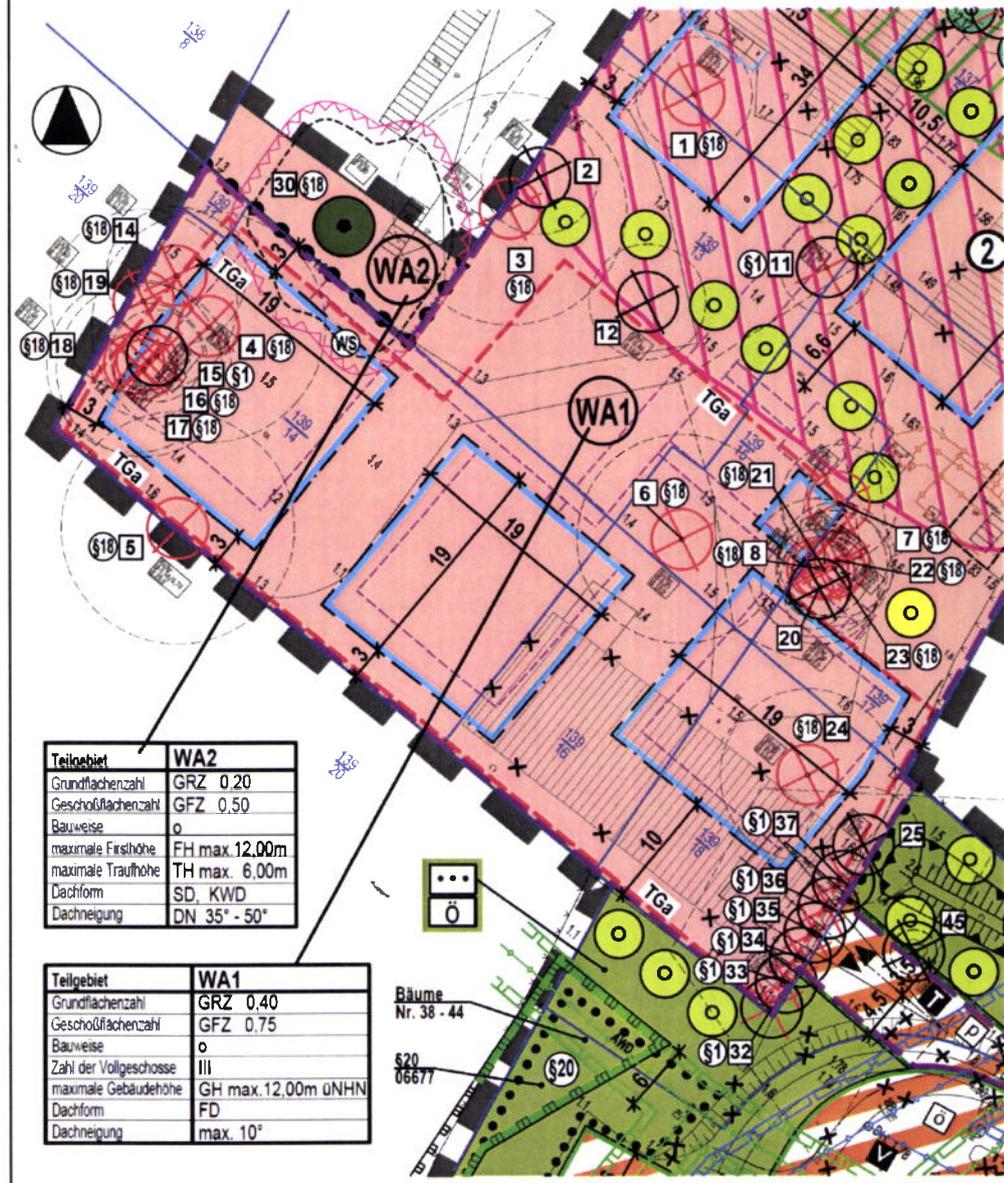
Kronendarstellungen des Baumes Nr. 30 nach Kronenpflegeschnitt
